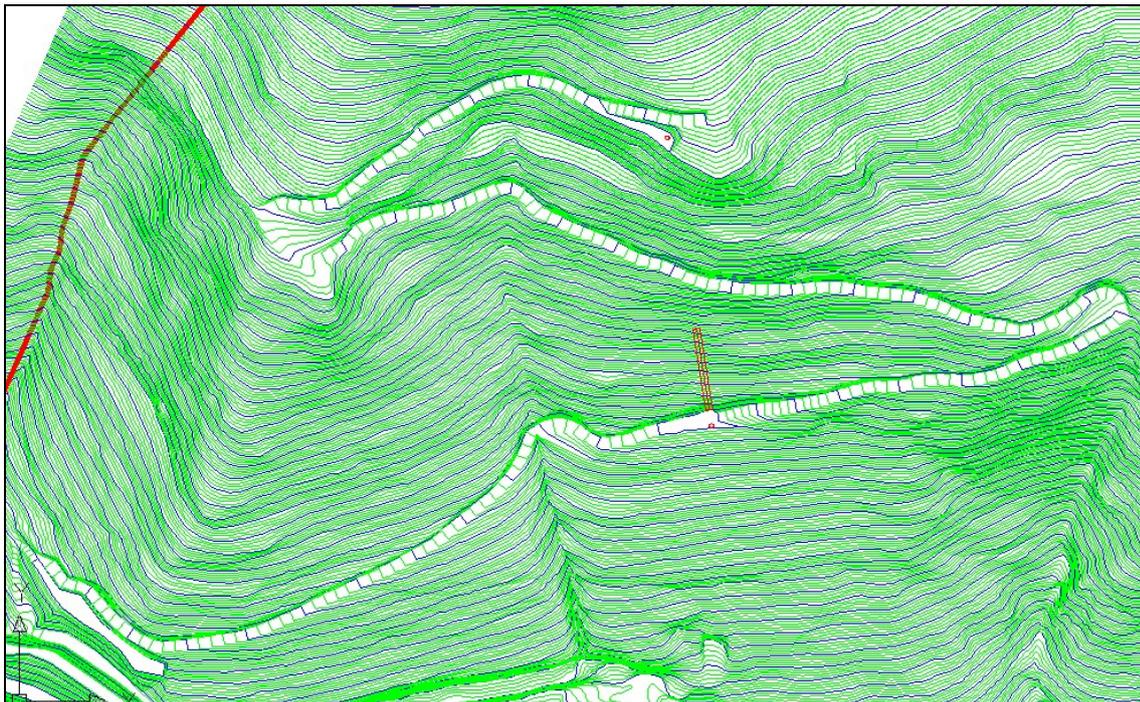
Rampa di arroccamento, galleria e tracce dei fornelli
